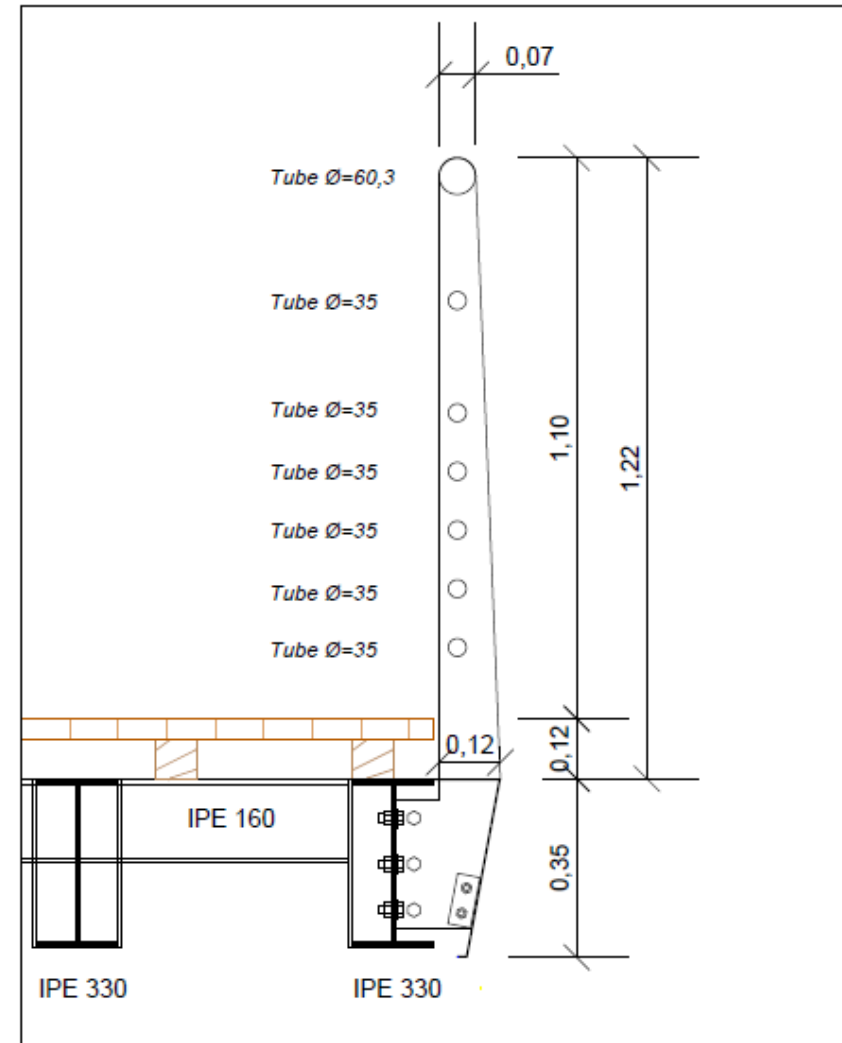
Ouvrage de la pointe du Château : profil en travers et détails garde-corps (source : CD56/Atelier Nāga)
